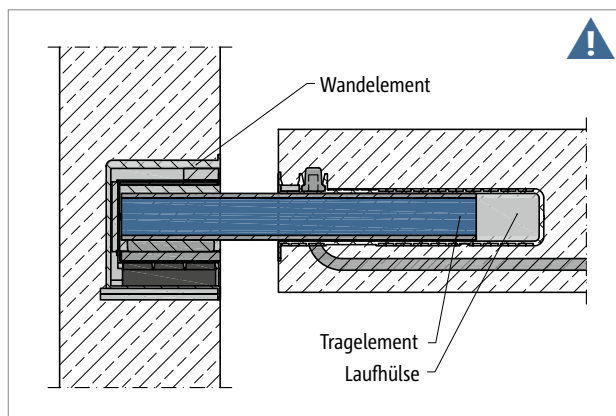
Tronsole® Q: Mehrteiliges Produkt (Wandelement, Tragelement, Laufhülse); Tragelement (eingefärbt) muss auf der Baustelle eingebaut werden.
